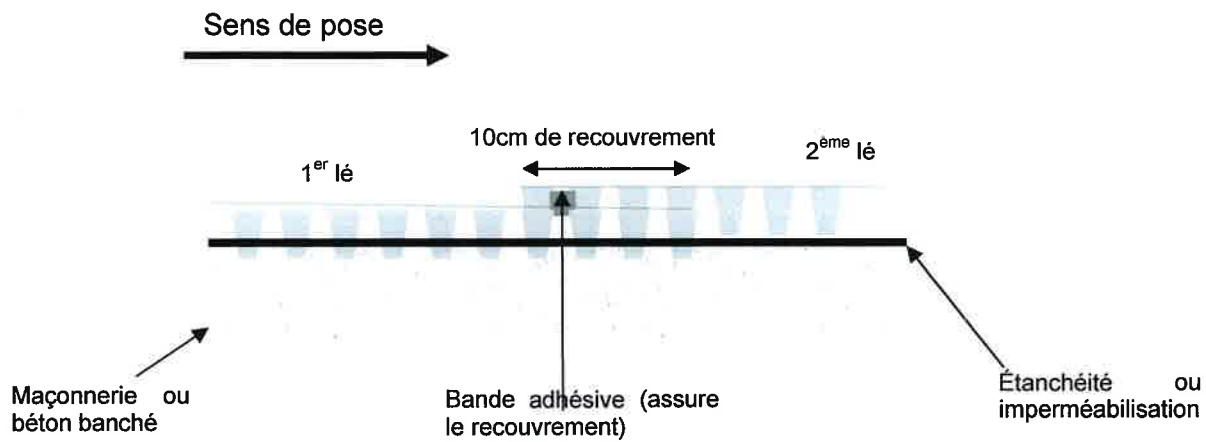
Recouvrement des lés CALINAPPE ST (coupe horizontale)
